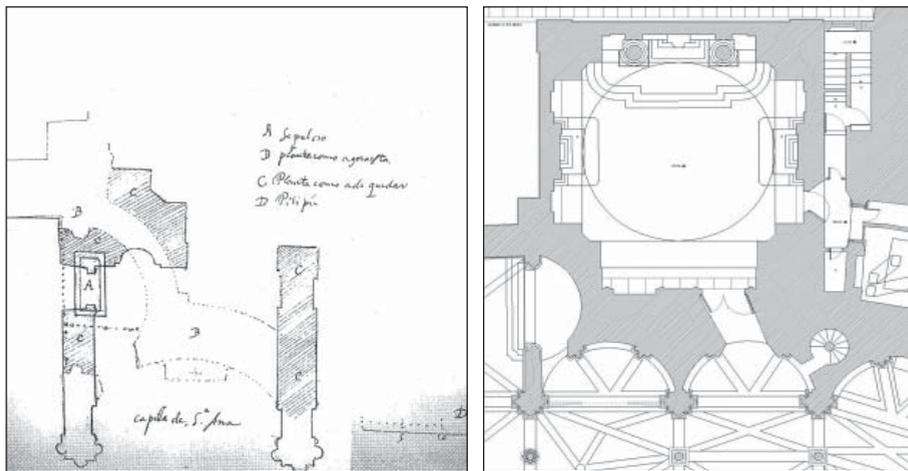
Boceto en planta del acceso a la capilla de los Velada, proyectado en 1612 (Biblioteca Francisco de Zabálburu. Madrid), imagen izquierda, y situación actual de este acceso (Feduchi, 2005), imagen derecha.
